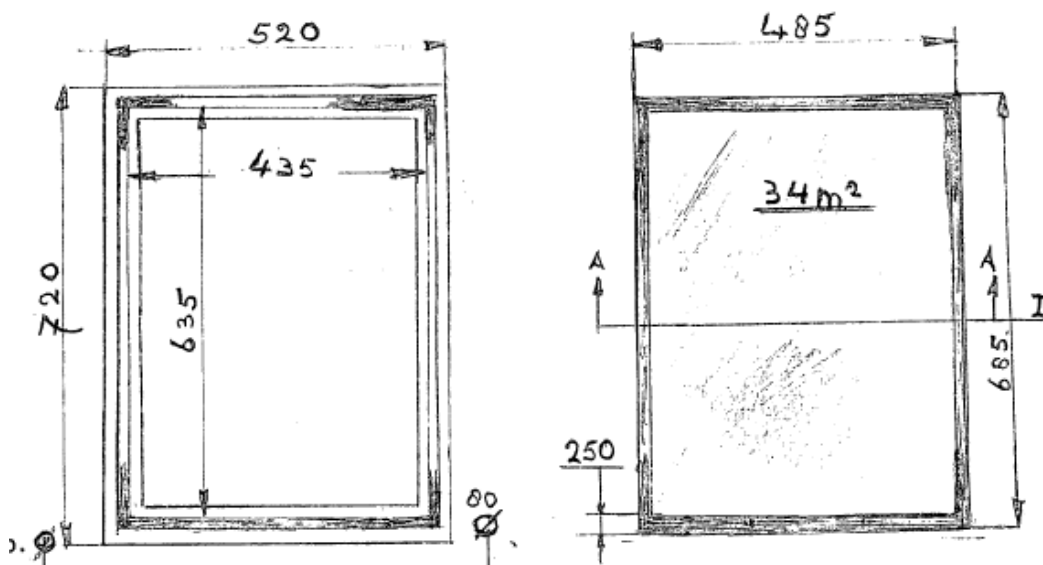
Dwarsdoorsneden bij een plan ter verbetering van het woonhuis (bron: opdrachtgever)
